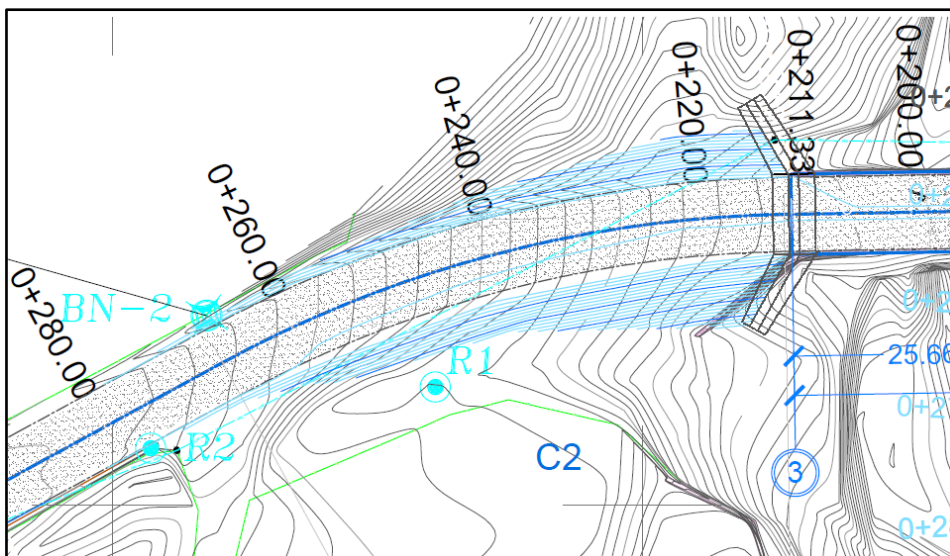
Planta del Acceso del Eje 3 del Puente Vehicular Tlaxmalac
